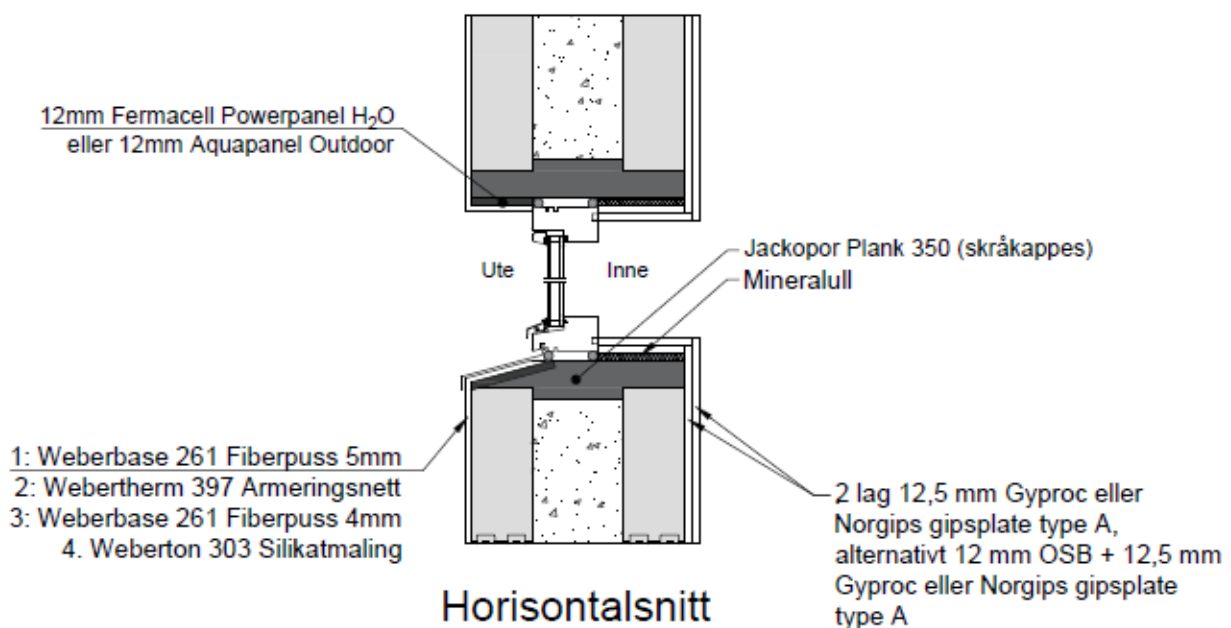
Fasade pusset med LIP pussystem. Jackopor Plank 350 rundt vindusutsparinger.
